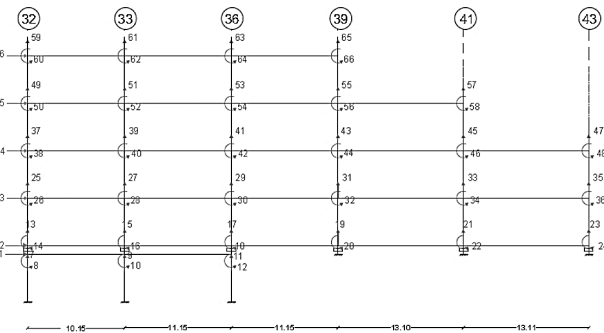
Estructura con aisladores analizado mediante CEINCI LAB.
